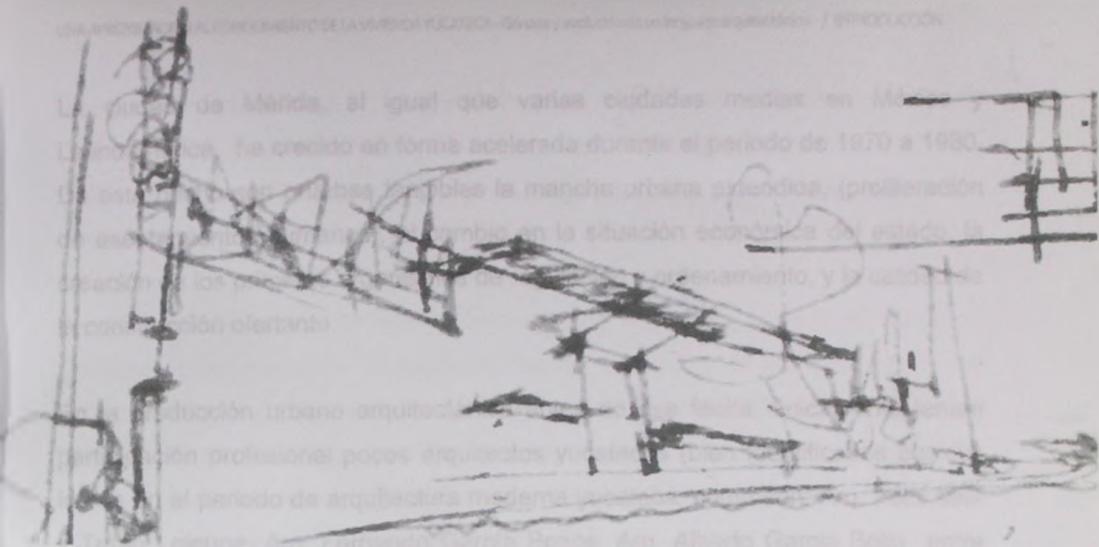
Croquis de la fachada exterior de la Casa Medina 2001
